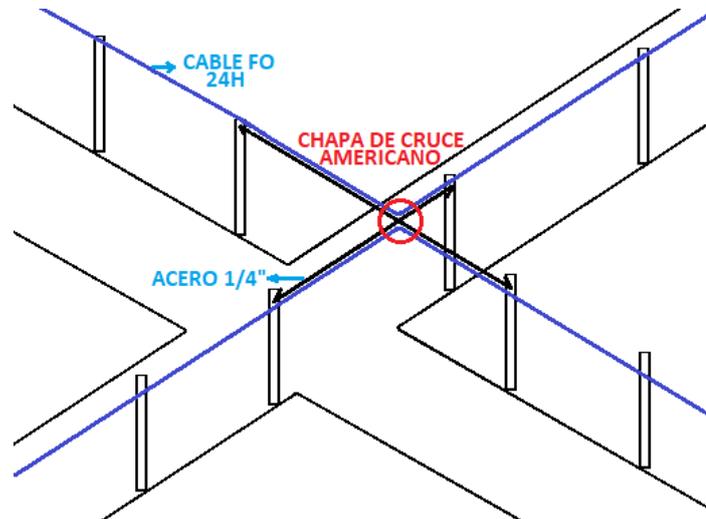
Instalación de F.O en cruce americano. Fuente: Elaboración propia
